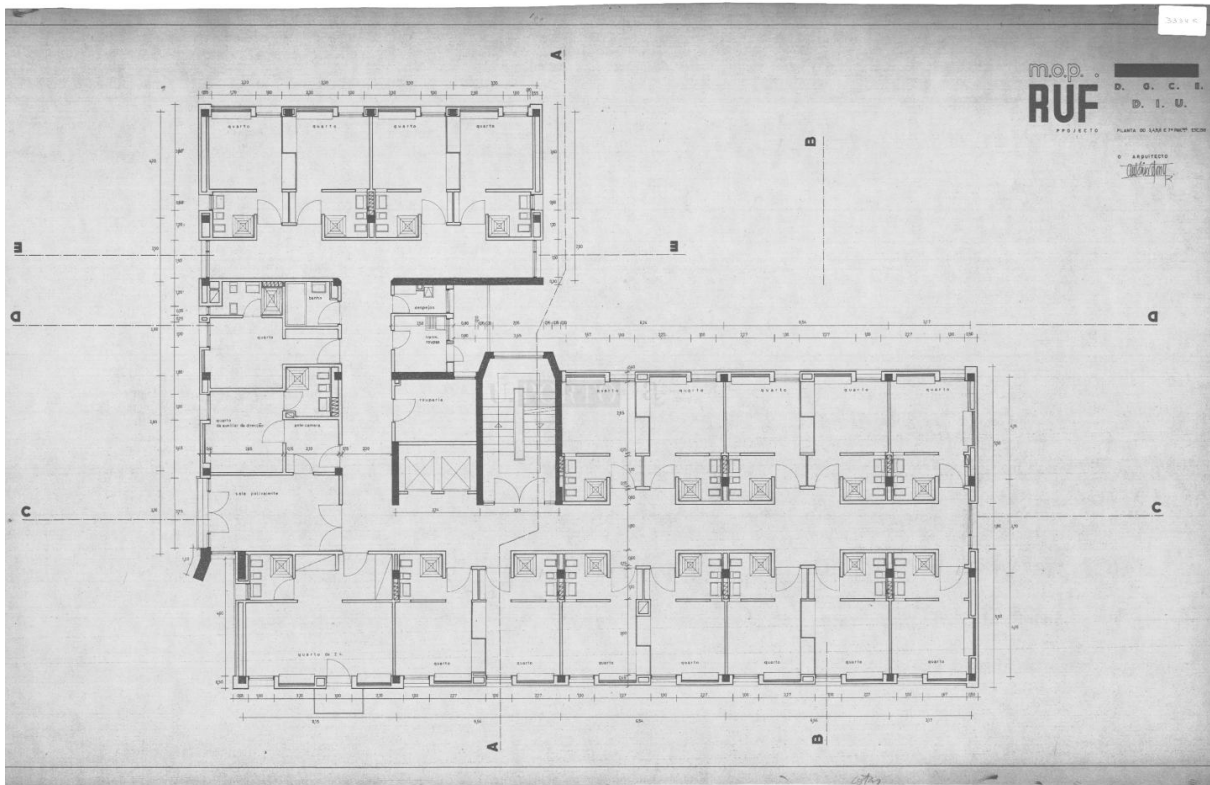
Planta esquemática do piso tipo na zona de dormitório.
